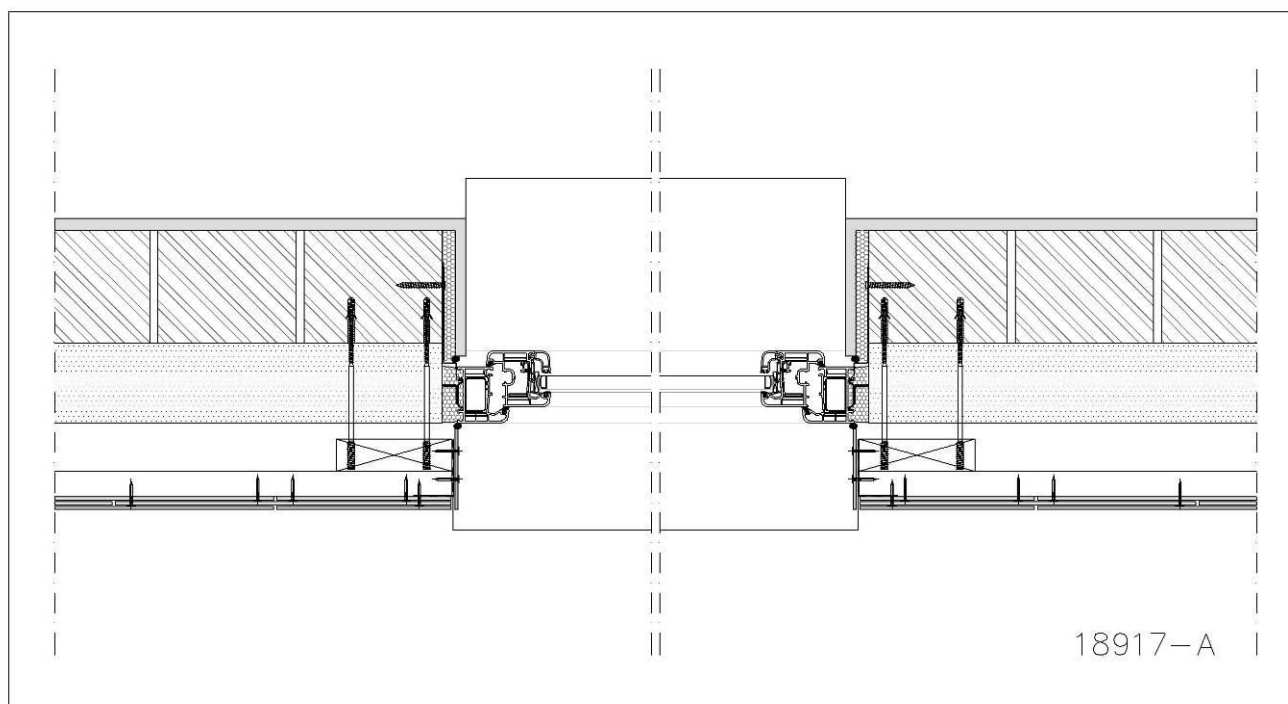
Exemple d'une finition avec fenêtre en retrait – finition classique – coupe horizontale
